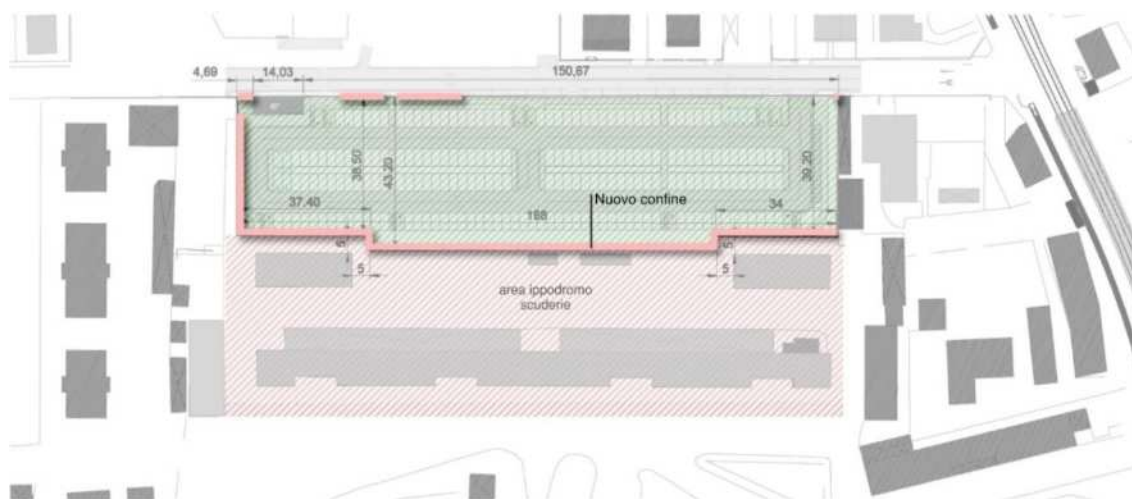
Stralcio planimetrico del parcheggio con, in evidenza le parti di muro mantenute e la giacitura della nuova recinzione a sud.
